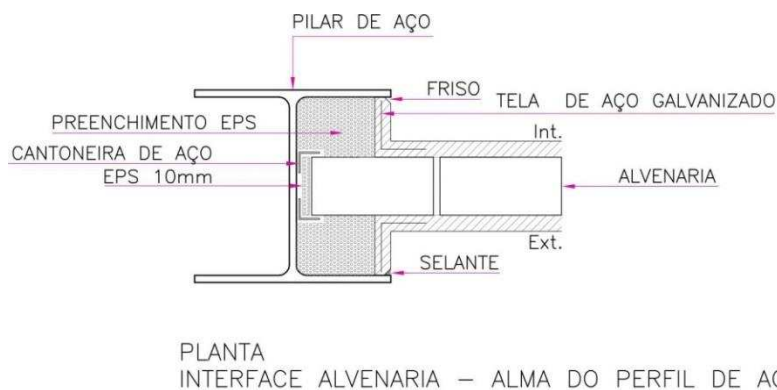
Detalhe da interface alvenaria externa – alma do pilar de aço.
